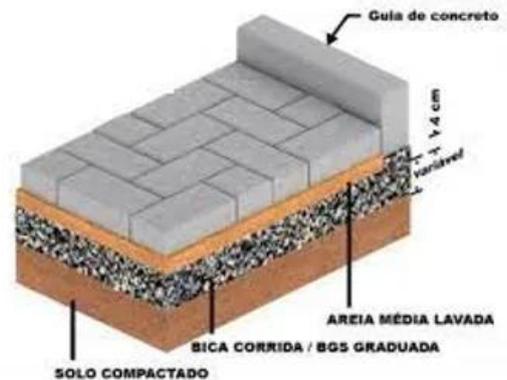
Ilustração de preparação do solo para receber os blocos de pavimento intertravado.
